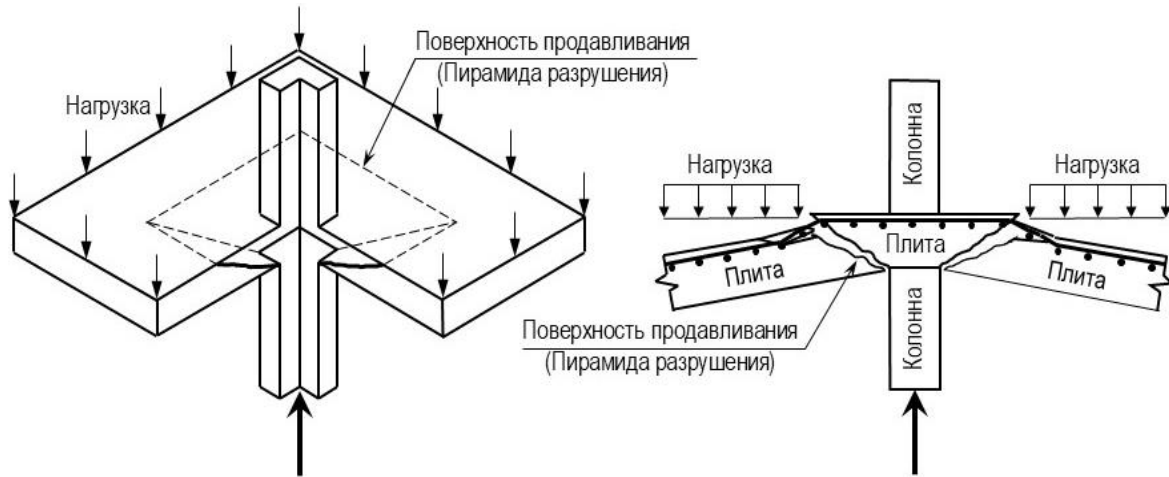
Схема продавливания в железобетонных плоских плитах без поперечного армирования [2]
